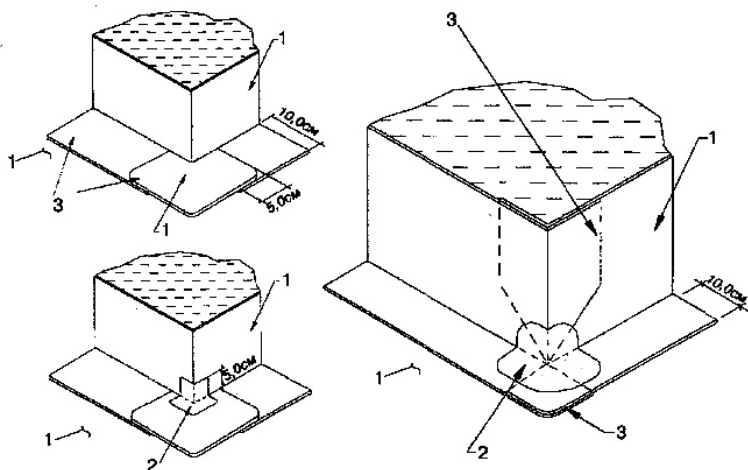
Устройство кровли на внешнем углу, например, вентиляхты (варианты):
